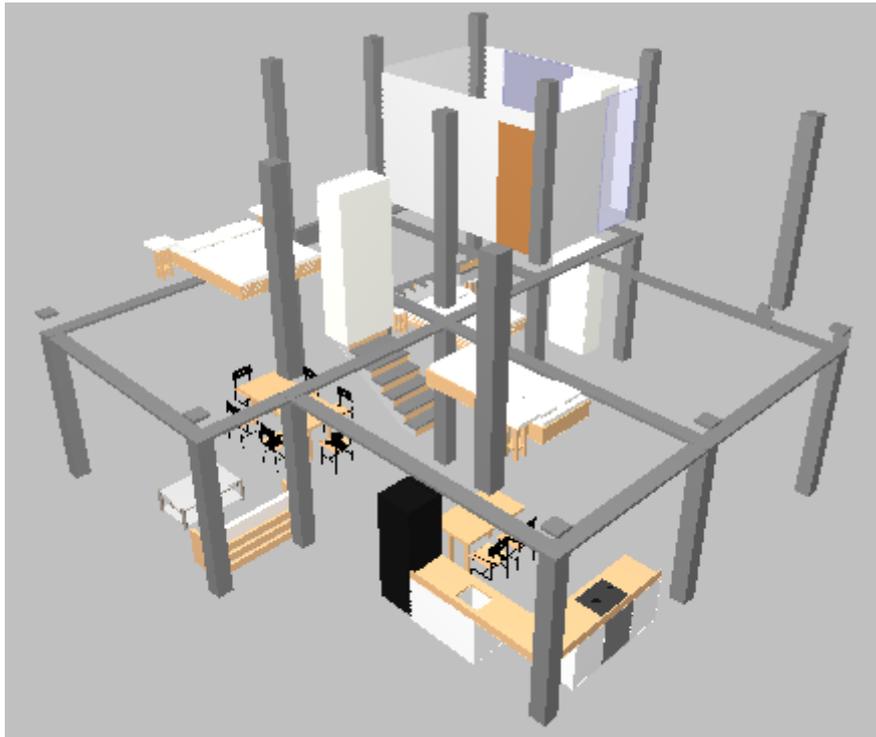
Archivo IFC de Revit importado en Cypetherm HE plus. Fuente: propia
